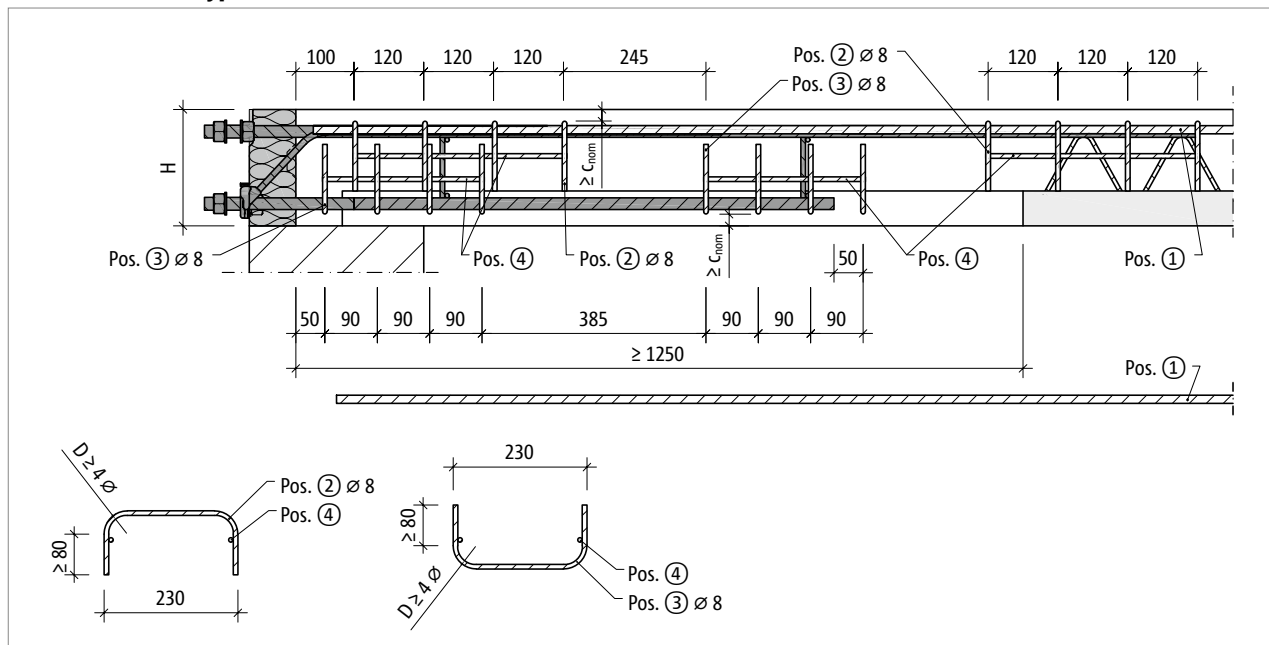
Schöck Isokorb® T type SK-MM2 : renforcement sur site pour mode de construction semi-préfabriqué avec étriers $\varnothing 8$ mm ; coupe
